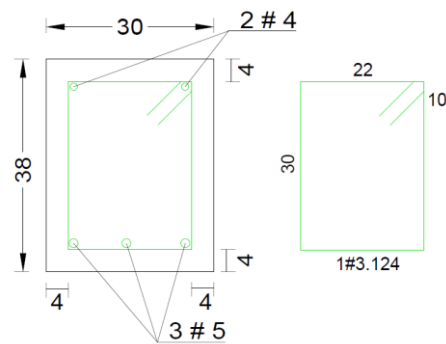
Sección transversal típica de las vigas en la experimentación
